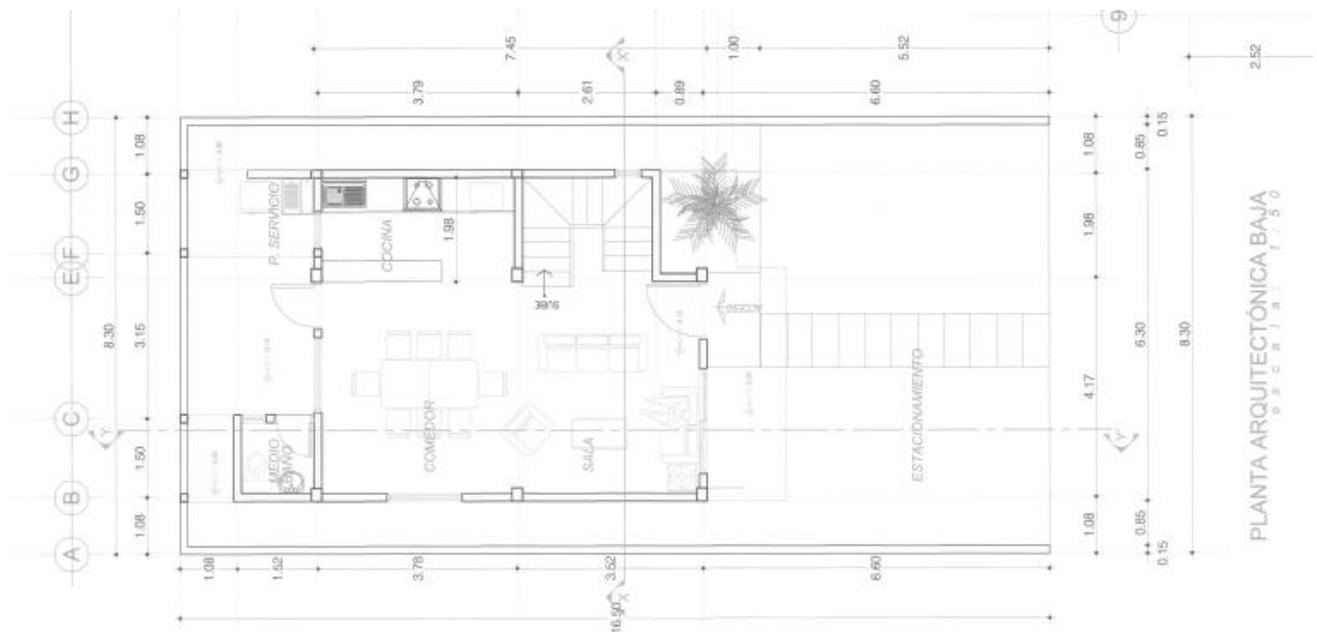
Plano arquitectónico de la Planta Baja de una vivienda tipo.
